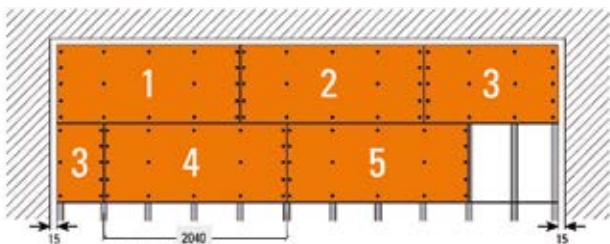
Disposição típica de vigas de suporte e fixadores.
